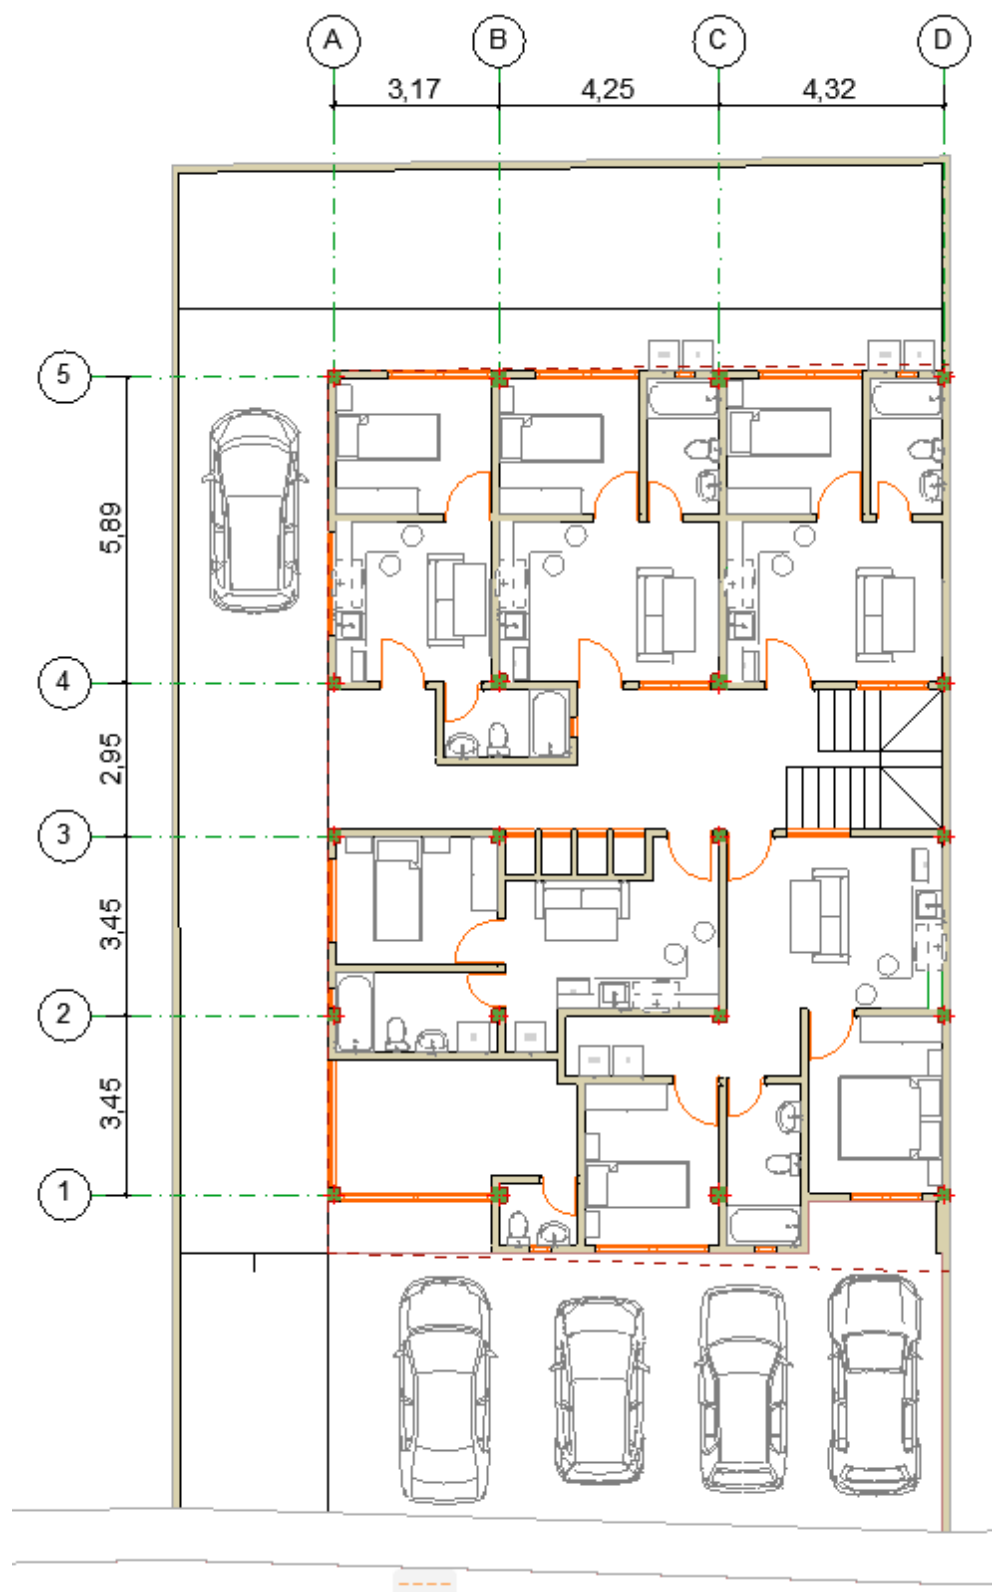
Captura de pantalla de Autodesk Civil 3D Modelo arquitectónico en 2D Planta baja
